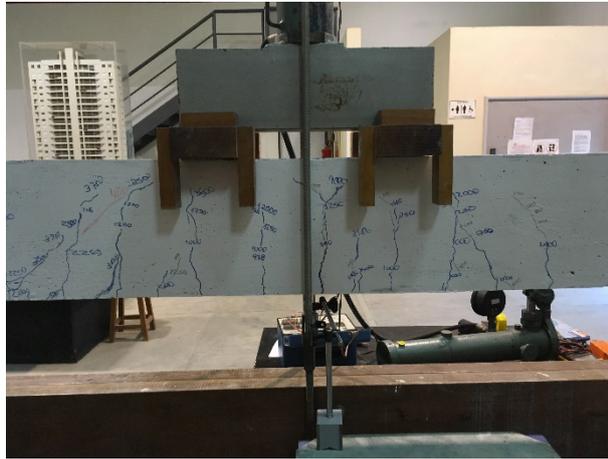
Padrão de fissuração ao final do ensaio
